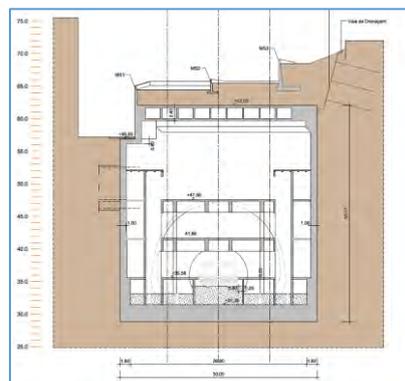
Estrutura do poço principal, estrutura interna e laje de cobertura
